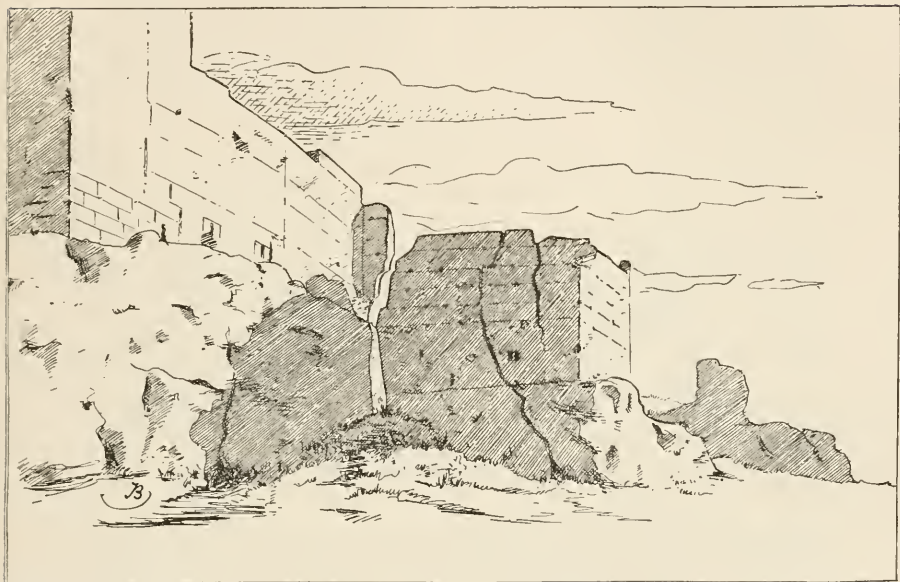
^a—Alcázar de Carmona.—Vista exterior indicando el desprendimiento causado en la muralla del Sur por el terremoto de 1504.
